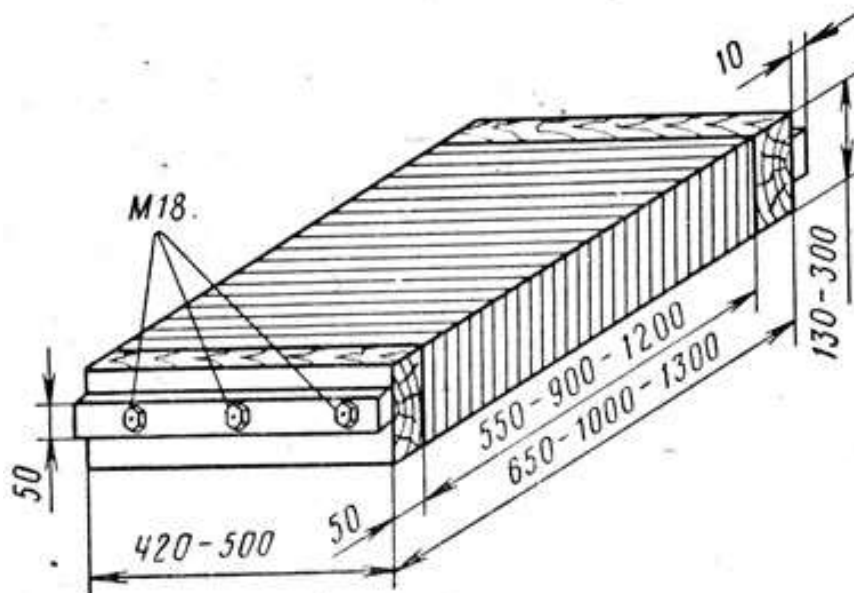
Торцева подушка з пресованих пластин шкіркартону
